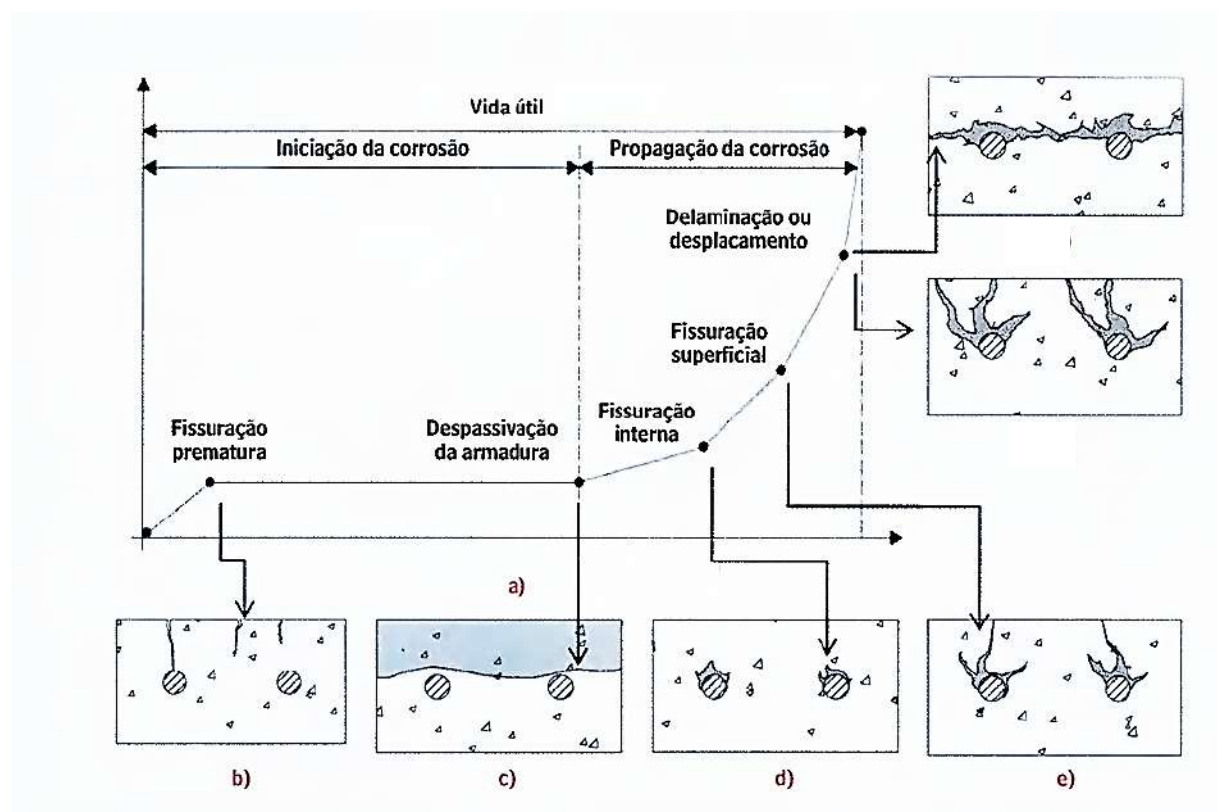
Ilustração das alterações típicas dos elementos em estruturas de concreto armado. Fonte: Adaptado de CUSSEON et al., 2011 apud TECHNE, 2017)
